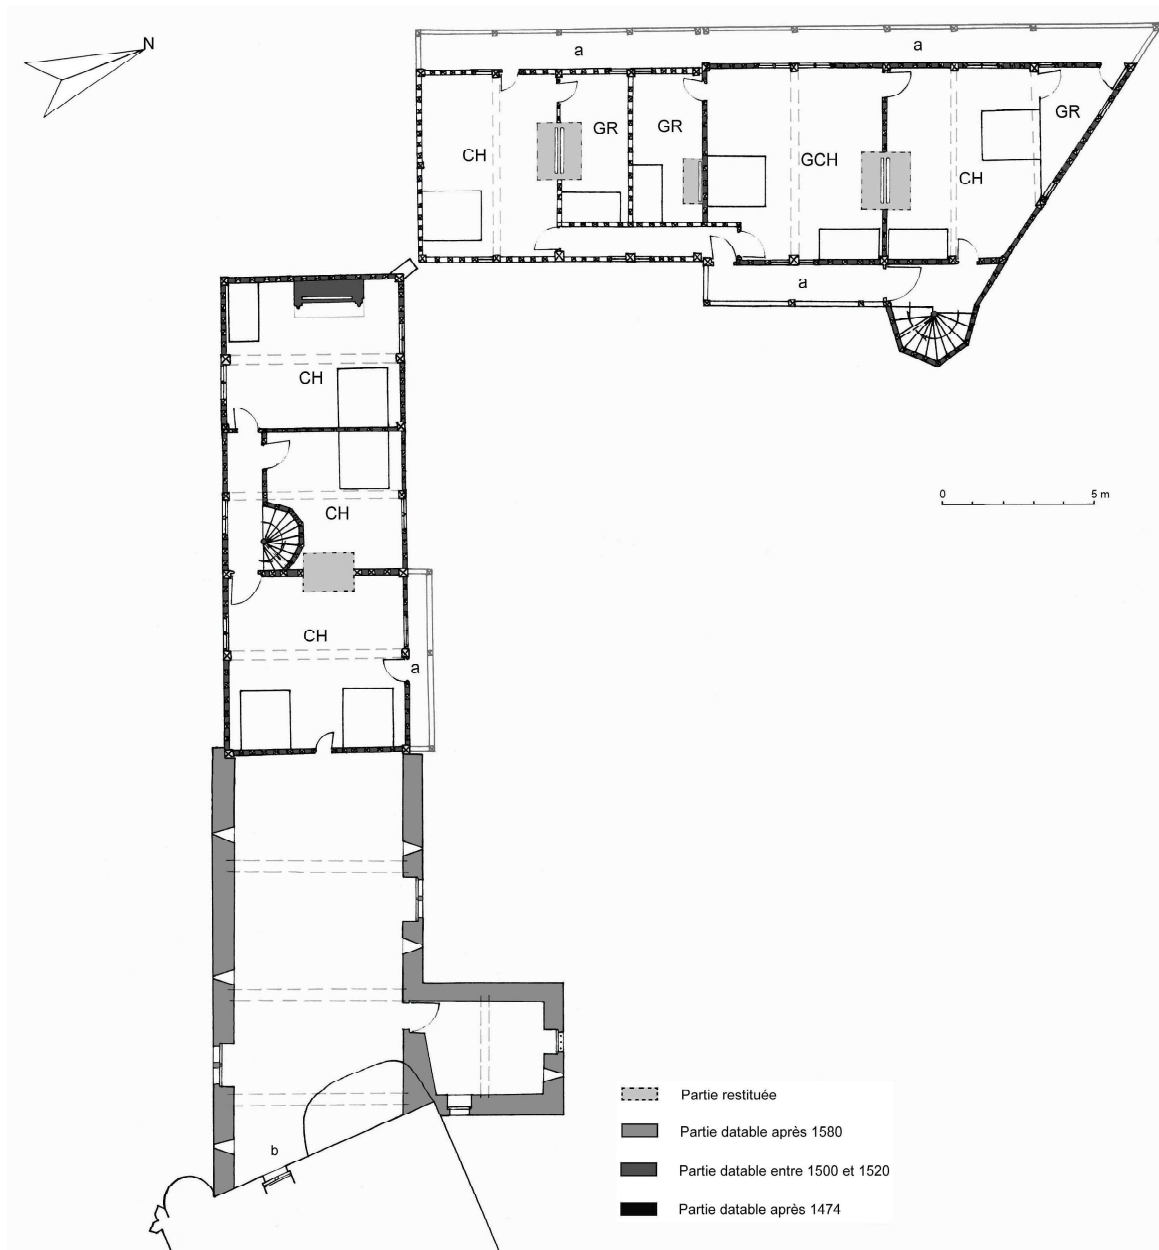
Le Mesnil-Jourdain. Plan restitué du premier étage.
